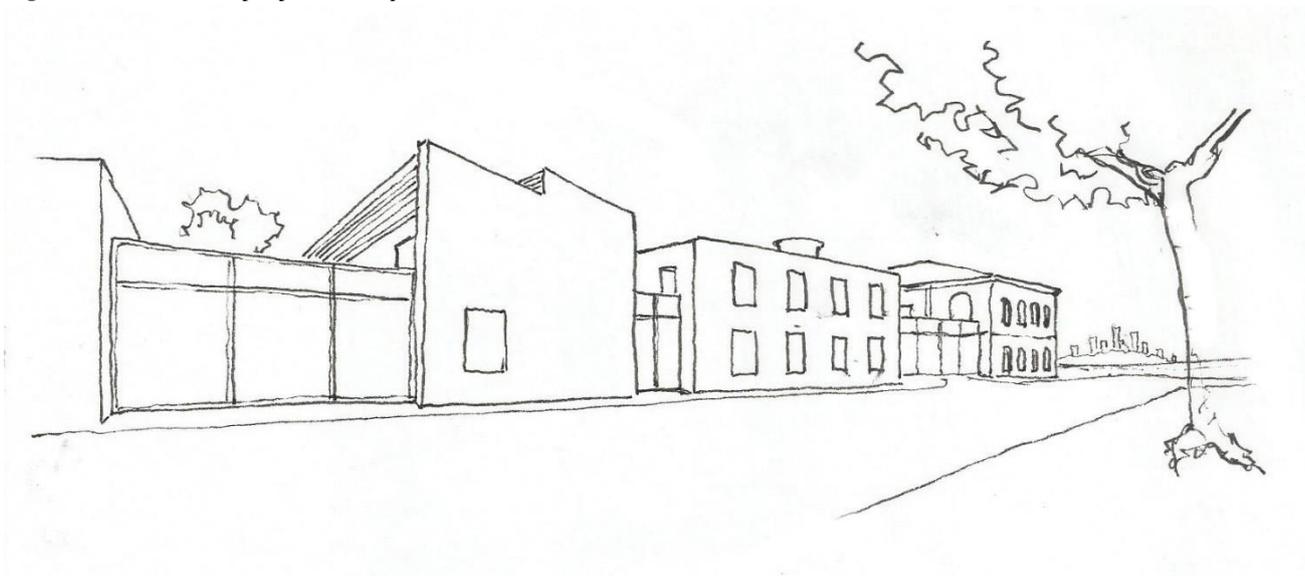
Fachada atual do conjunto da Fábrica Leão do Norte.
